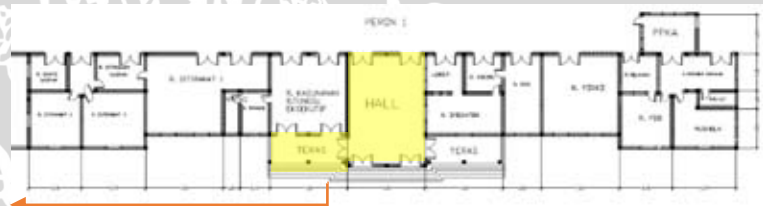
Kondisi eksisting tipe jenis lantai 1 pada bangunan stasiun Solo Jebres
